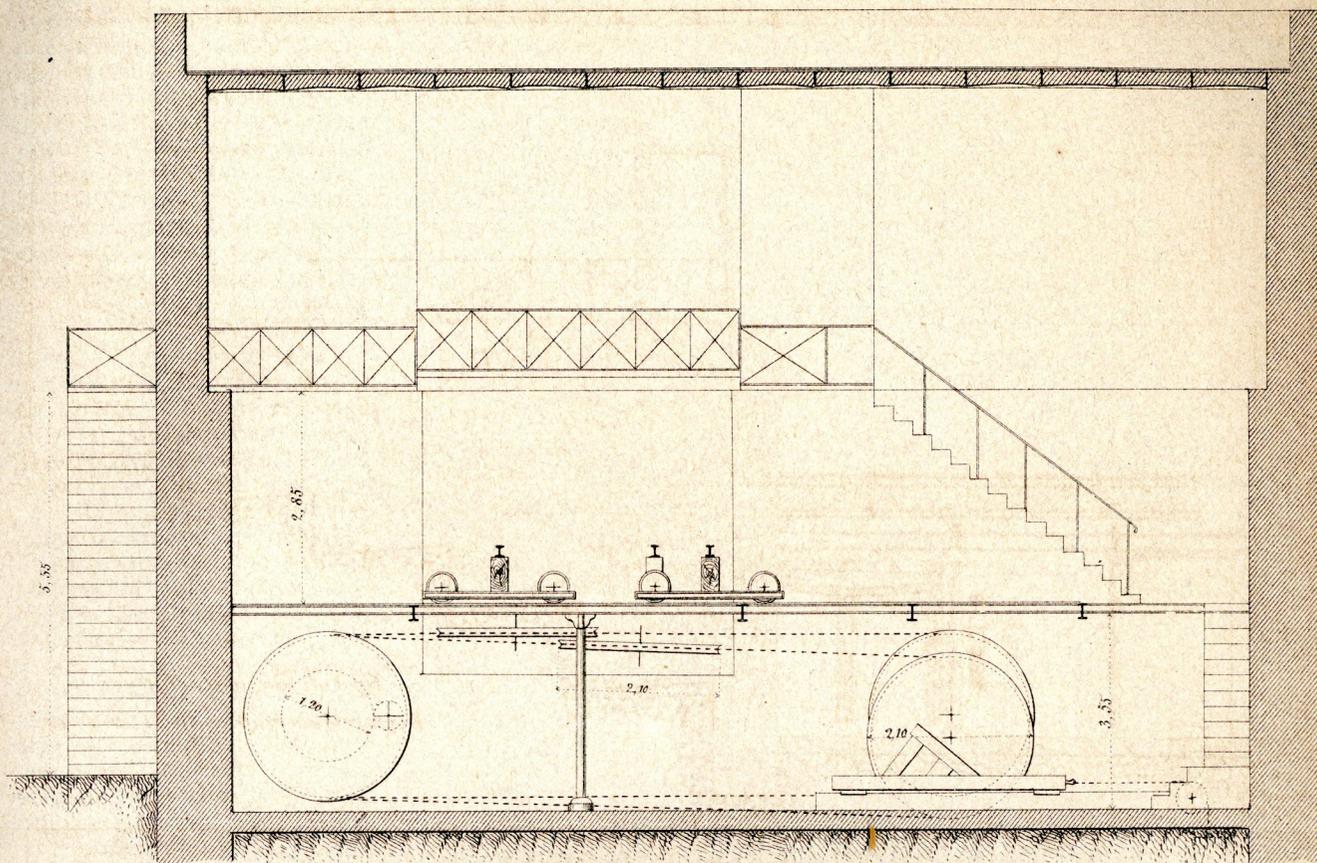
Stazione inferiore. Sezione secondo C D. Scala di 1 : 100.
